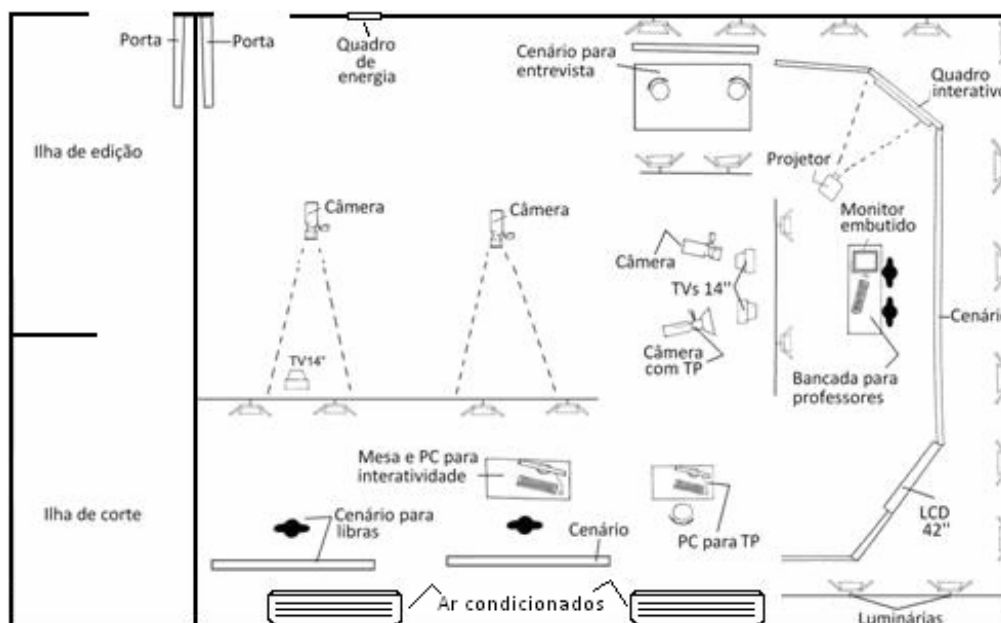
Planta baixa do estúdio Tocantins – EADCON 5 (Desenho: Geovar Silva de Oliveira).
